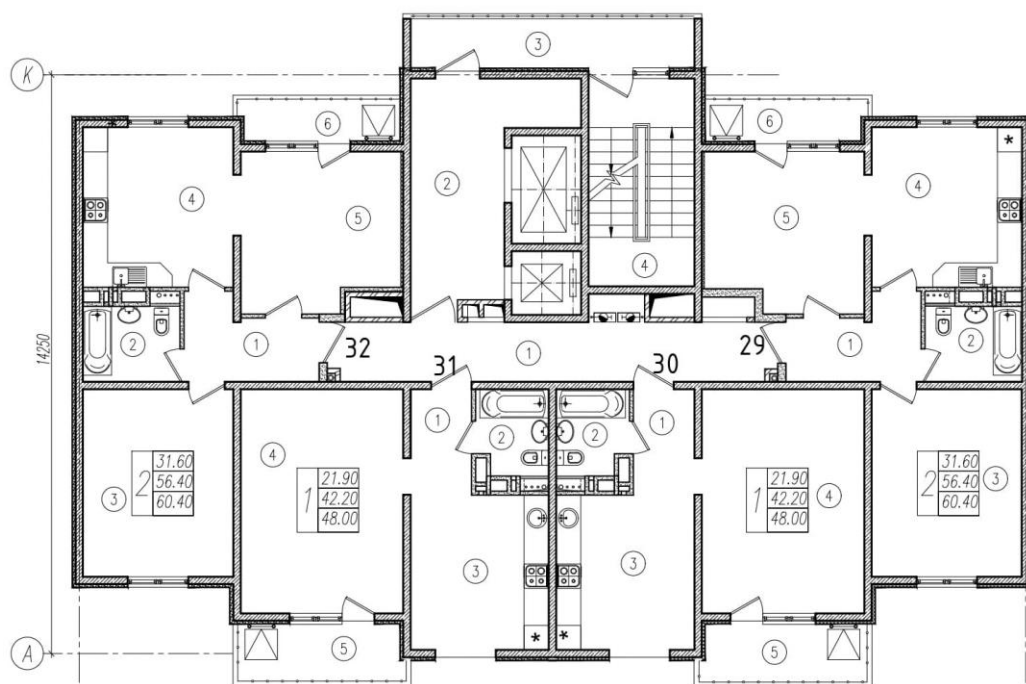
План 9-16-ого этажей 5 литеры ЖК «Горный квартал»
